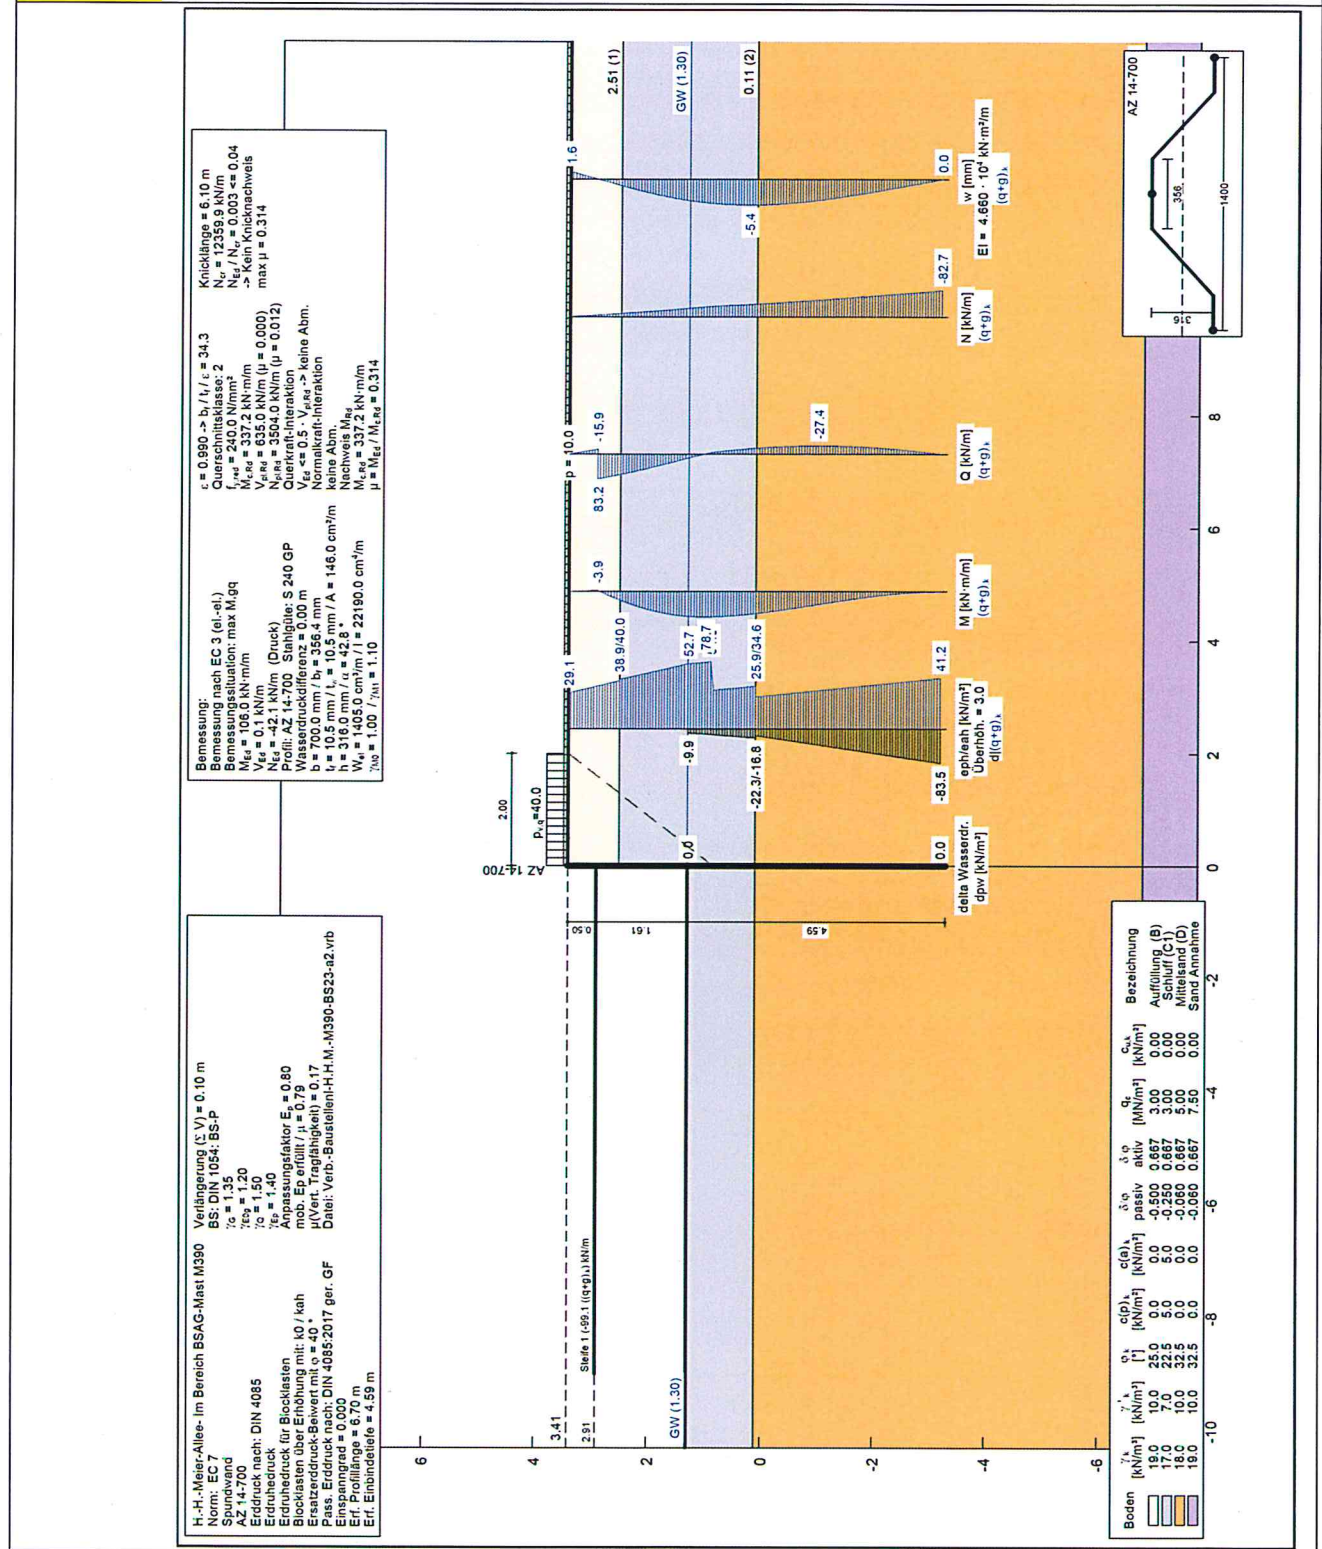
b2 Erddrücke Mit Strassenbahnlasten+Mast – BS23 max M_{Mast} -b2
